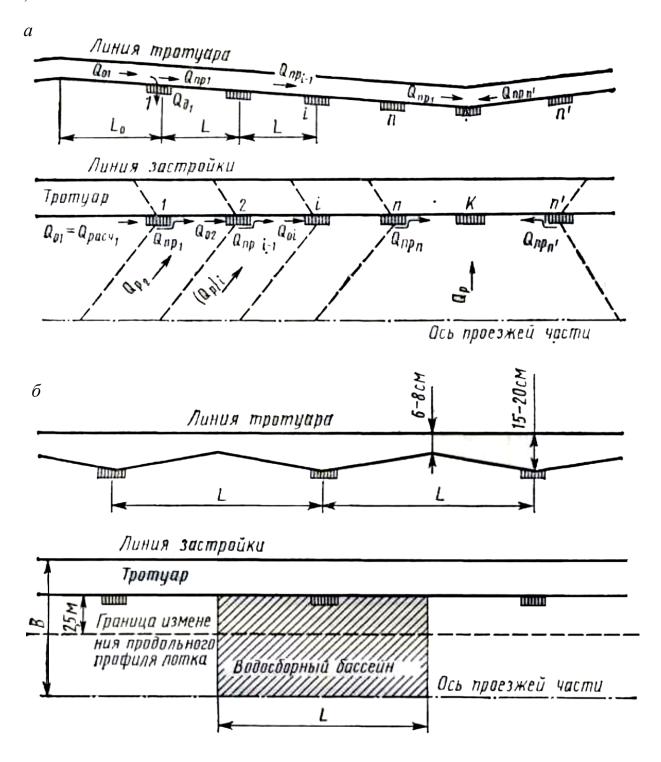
Расчетная схема к определению расходов воды в лотке перед дождеприемником a –лоток с продольным уклоном одного знака на участке затяжного спуска; δ – лоток с пилообразным продольным профилем
